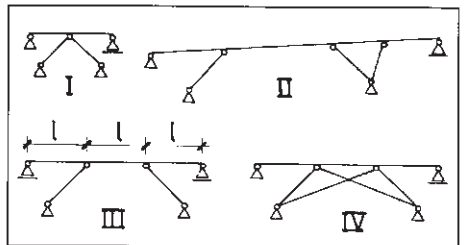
Mögliche statische Systeme: I) einfaches Sprengwerk, Versteifungsträger mit Gelenk, II) unsymm. dreifaches Sprengwerk, III) und IV) Trapezsprengwerke
